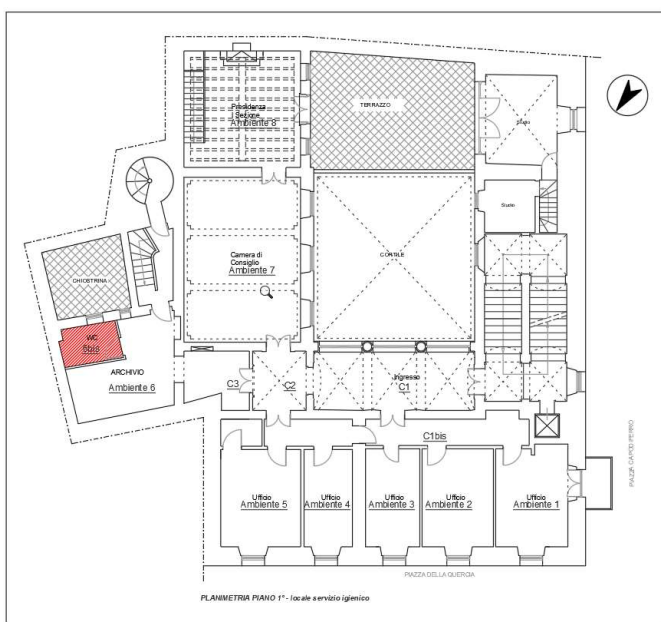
Planimetria piano primo Palazzo Ossoli - servizio igienico da adeguare per disabili
